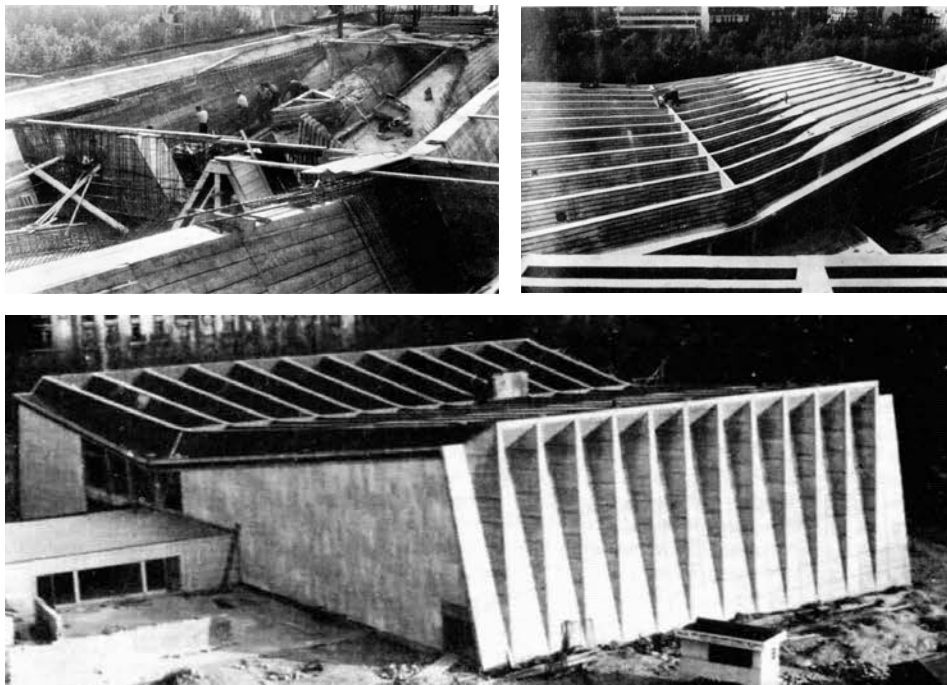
Secuencia de construcción del proyecto Audience Hall Vatican (Nervi, 1964-71).
